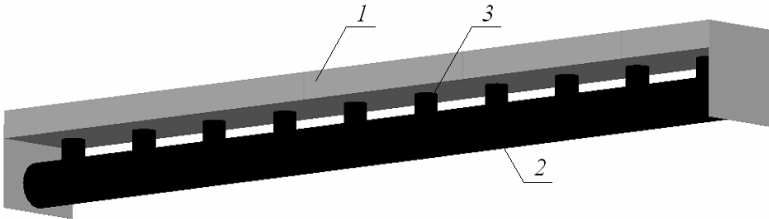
Сталезалізобетонна балка з армуванням трубою
